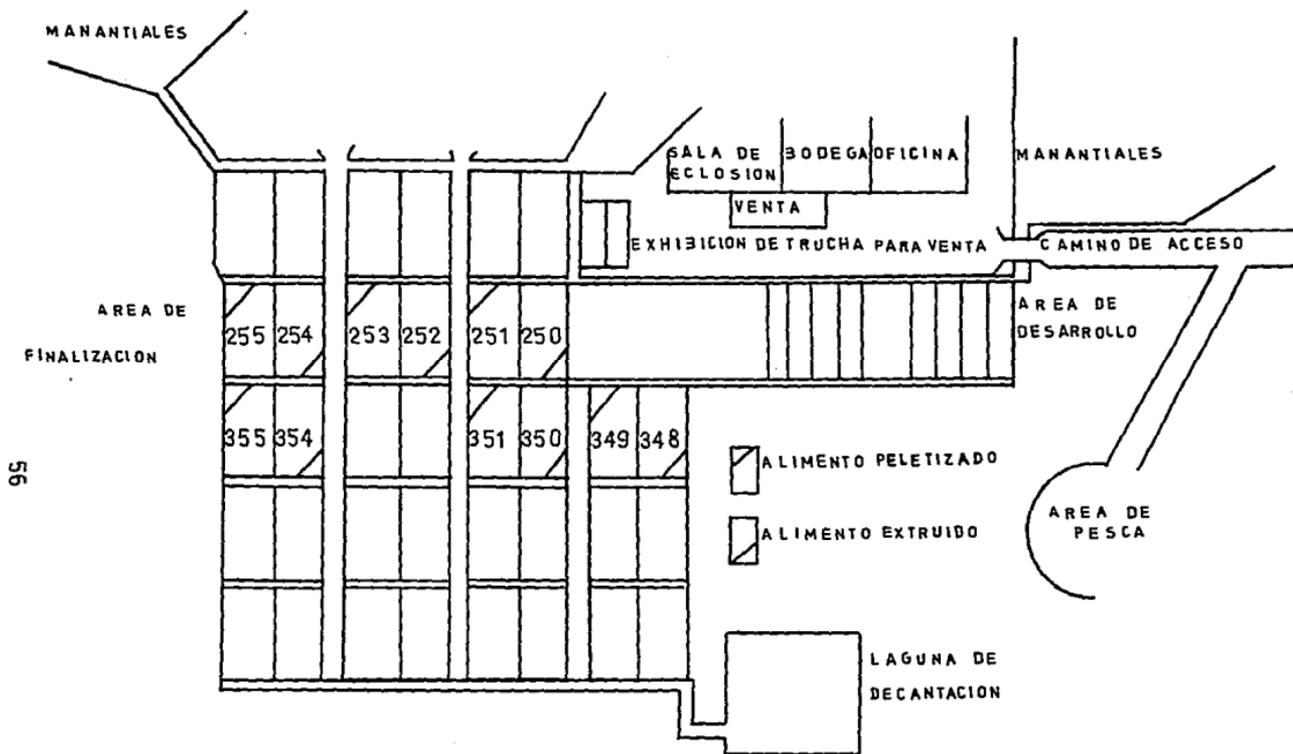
PLANTA ESQUEMATICA DE LA GRANJA DE TRUCHA
